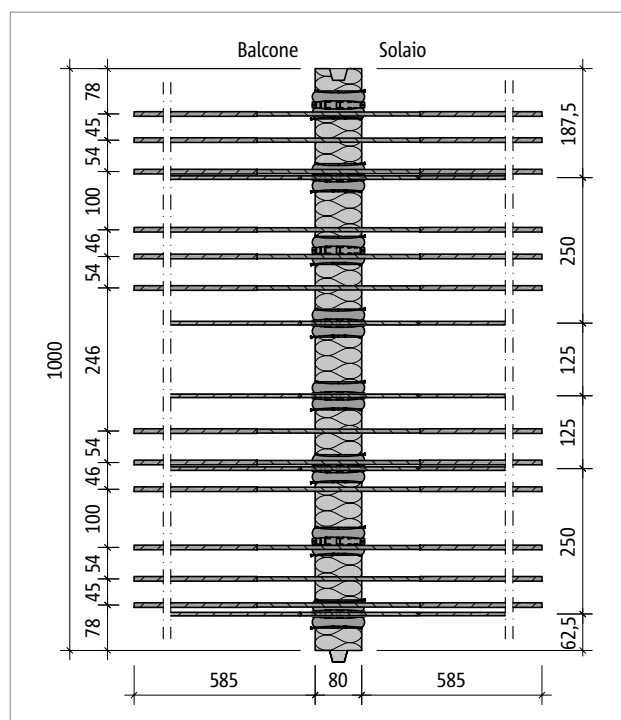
Schöck Isokorb® T tipo K-M4-V1: pianta del prodotto
